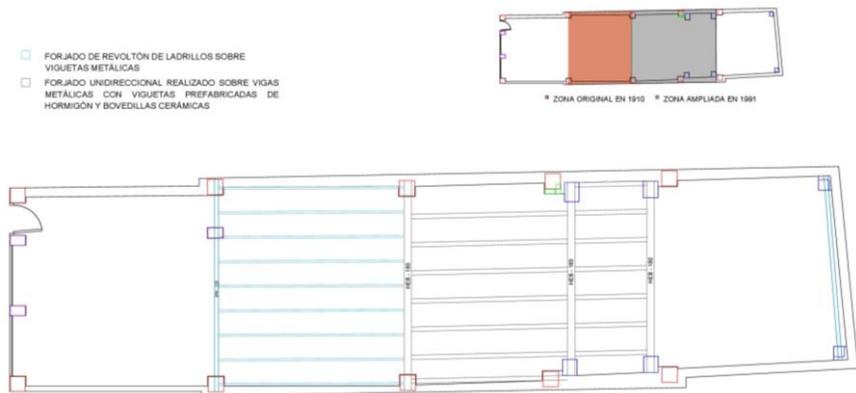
Plano de ampliación de forjado planta intermedia. 2018 Fuente: Propia
